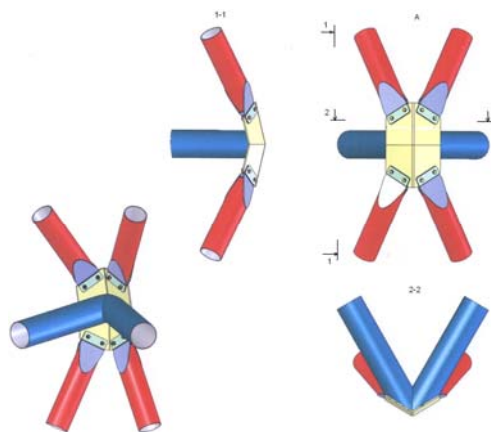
Узловые элементы крепления трубчатых универсальных стержней
